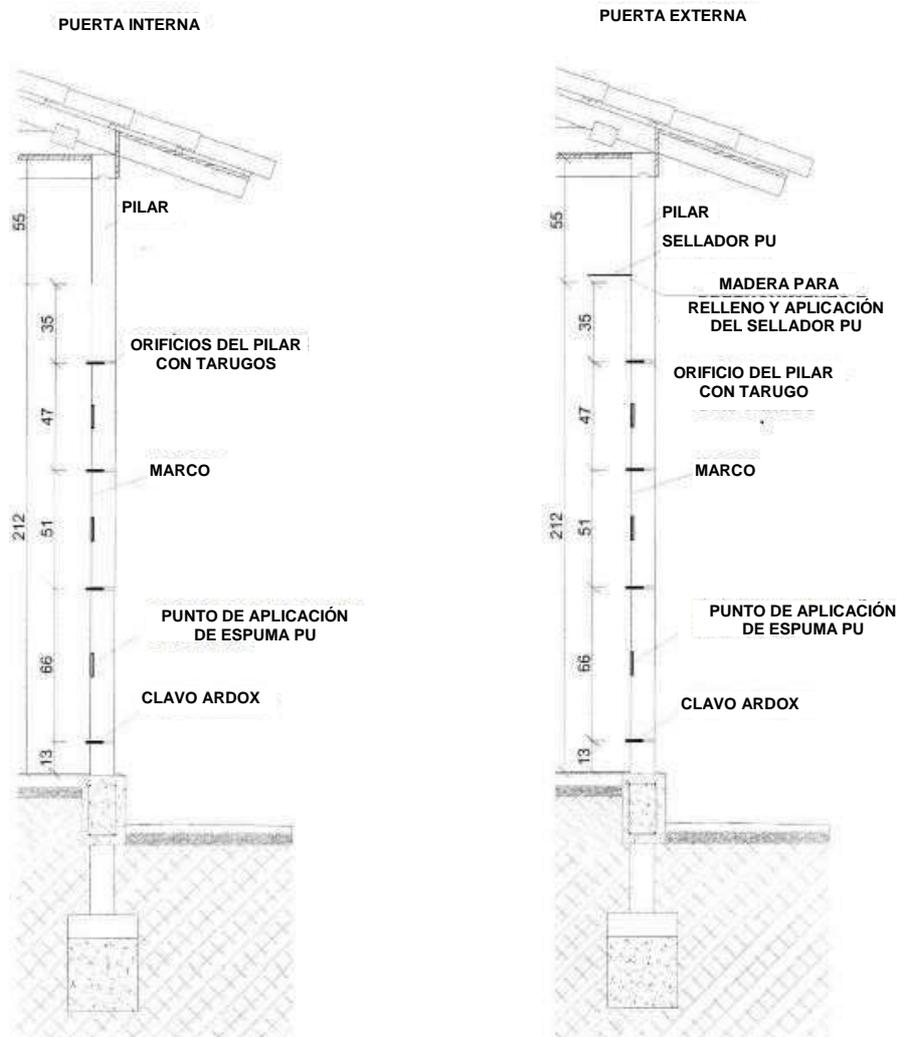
Diseño esquemático de la fijación de los batientes de puerta en los pilares prefabricados.
